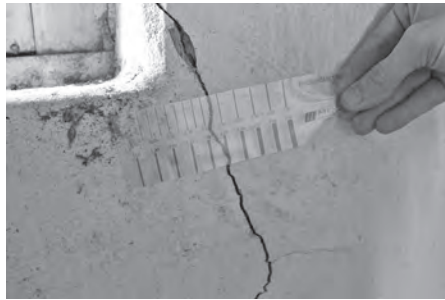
Fissura ou rachadura próxima à abertura de uma edificação
